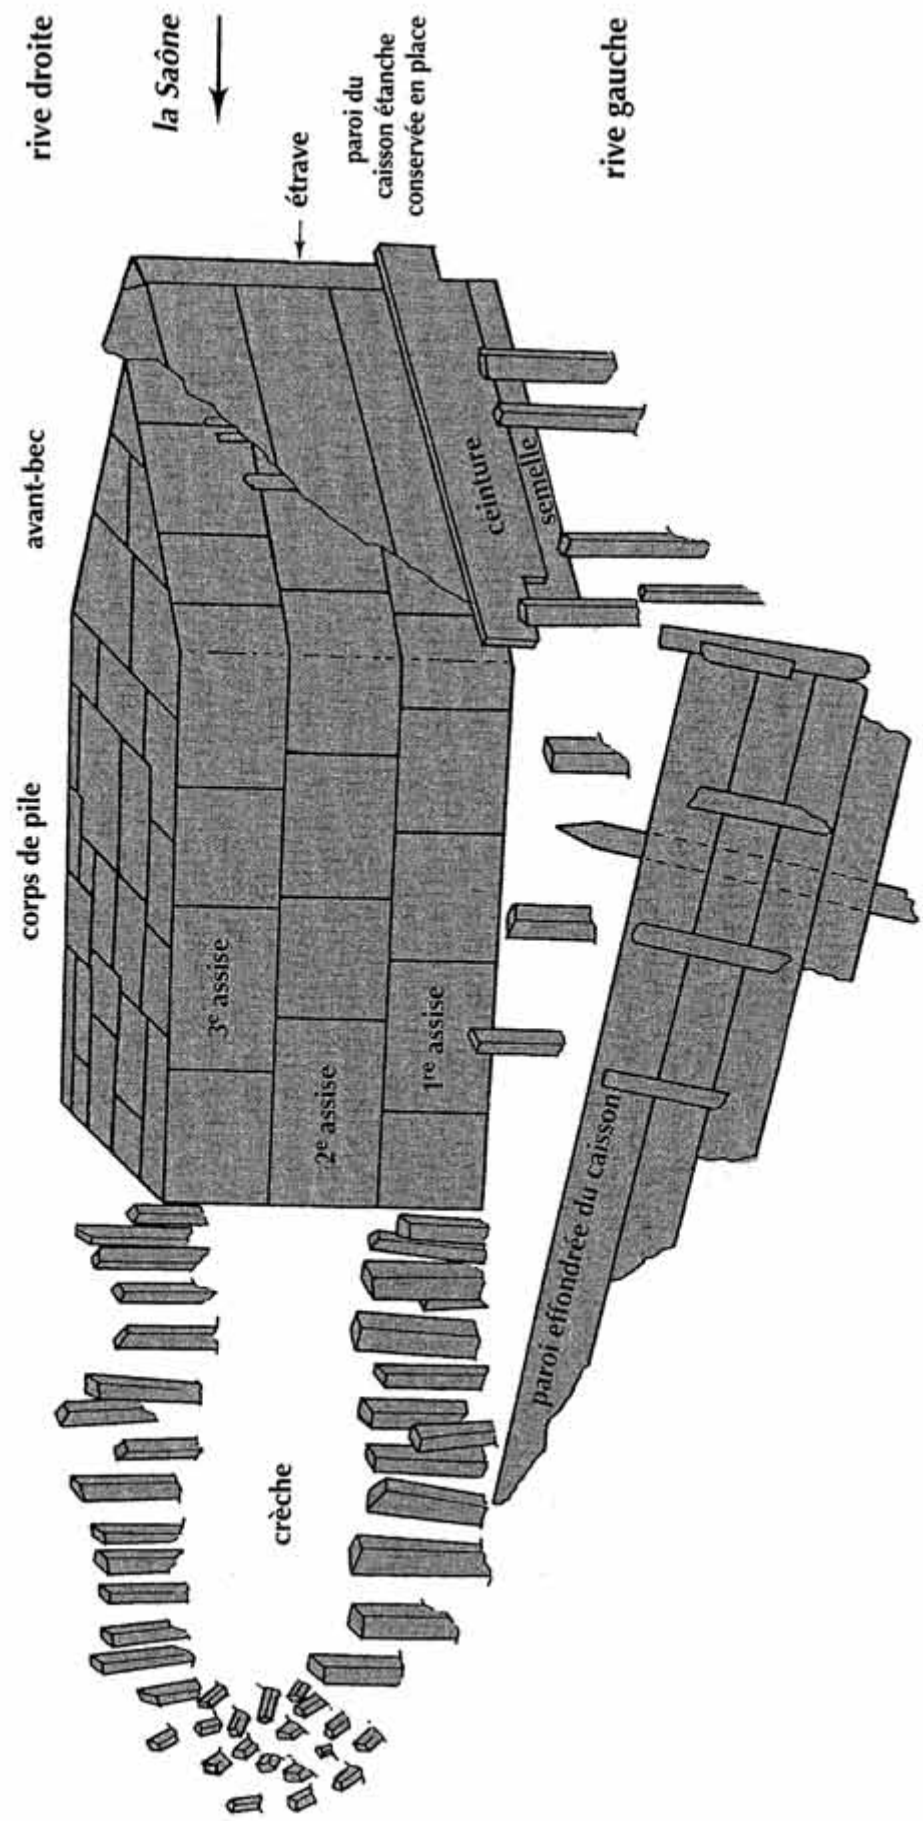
Chalon-sur-Saône, Pont Saint-Laurent. Pile n° 3.
